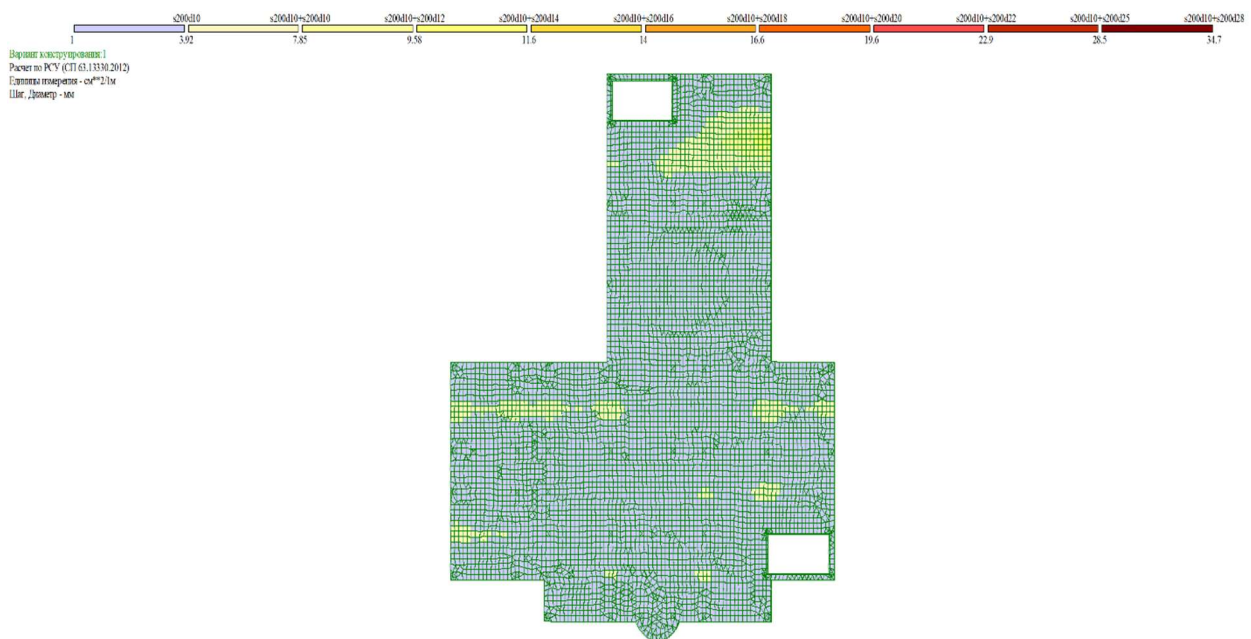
Нижнее армирование плиты фундамента по оси Y
